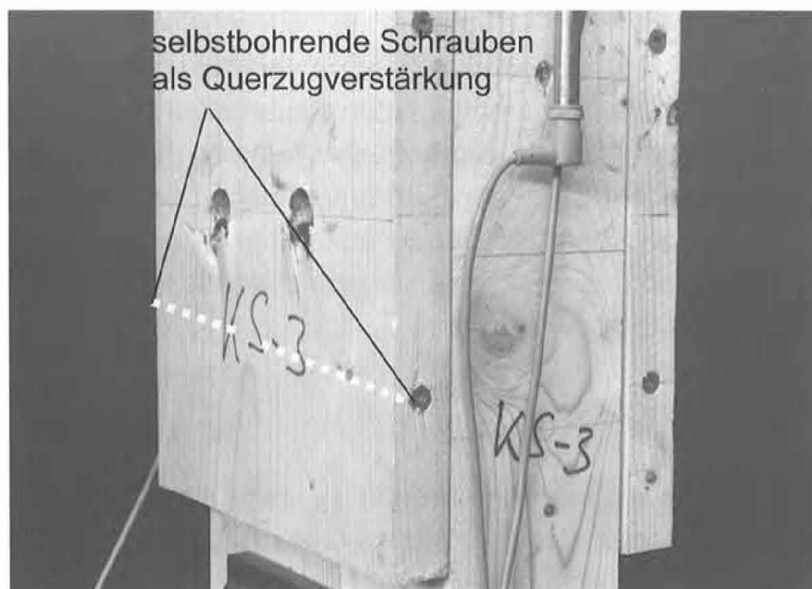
Prüfkörper mit Querkzugverstärkung durch Vollgewindeschrauben
